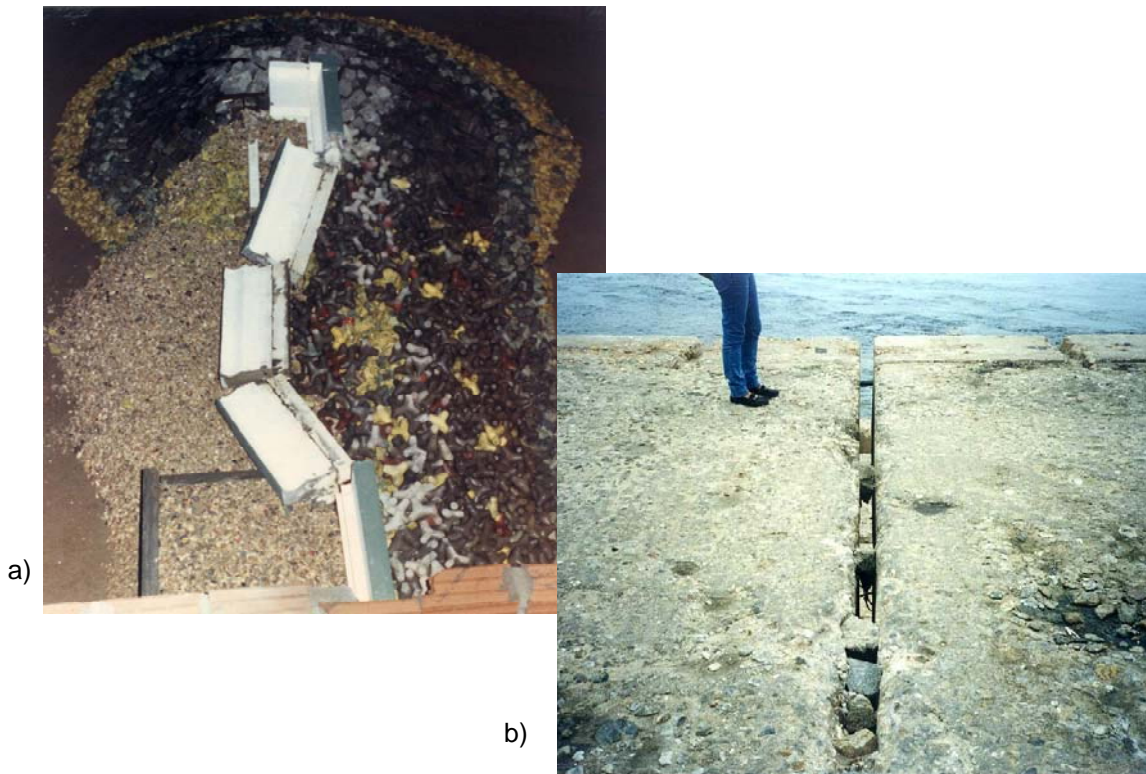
Causas mais comuns da rotura da superestrutura de um quebra-mar: a) Instabilidade global dos elementos que constituem a superestrutura (fotografia de um modelo ensaiado no LNEC); b) Aspectos construtivos (aspecto das juntas de construção já com uma abertura significativa).
